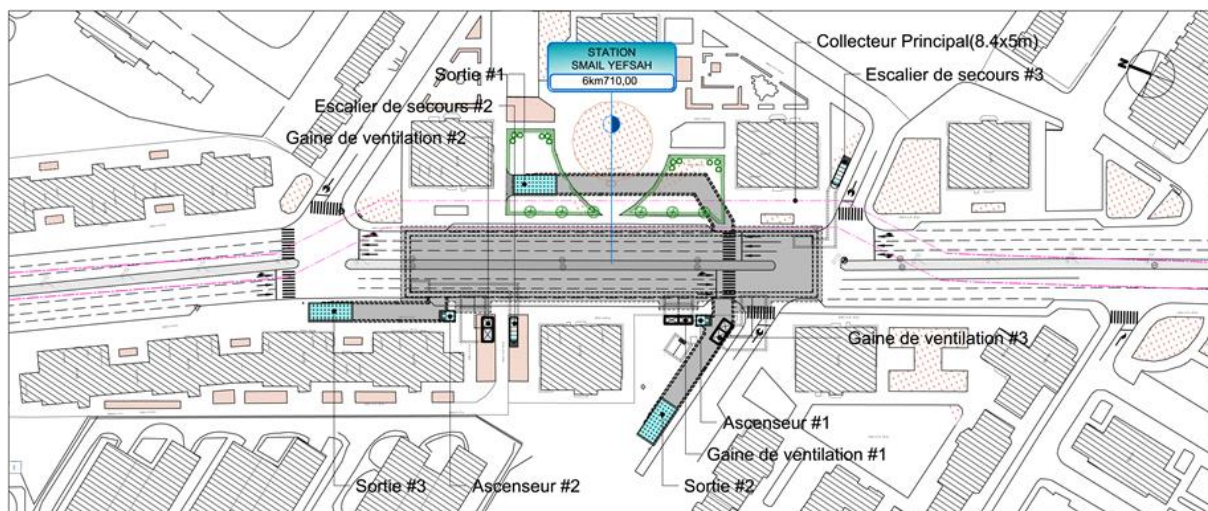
Vue en plan du niveau dalle de couverture R0 (DOHWA,2015)
